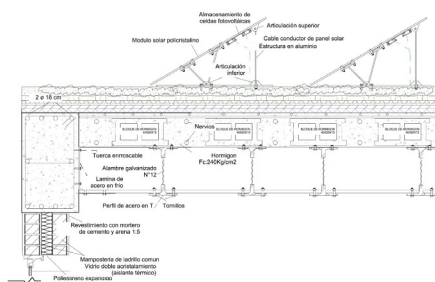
Detalle constructivo de paneles fotovoltaicos. Fuente: Elaboración propia
